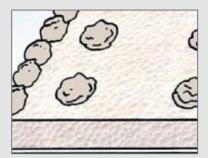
Application d'une mince couche continue de mortier colle en haut du complexe
